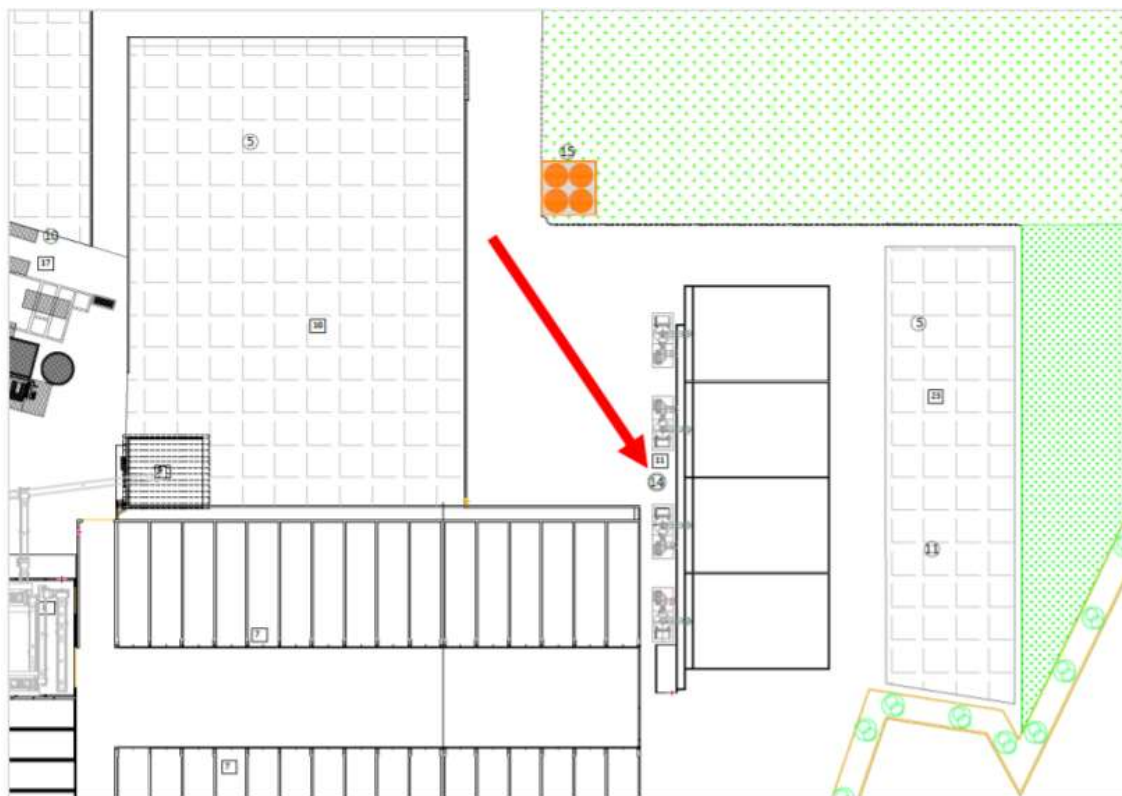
Stralcio planimetria T6.1 con evidenza del serbatoio di deposito reagenti
